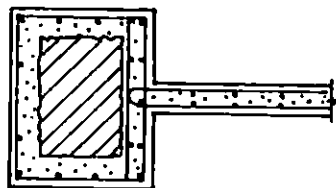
MURO DE RELLENO UNIDO A COLUMNA POR ENCAMISADO
